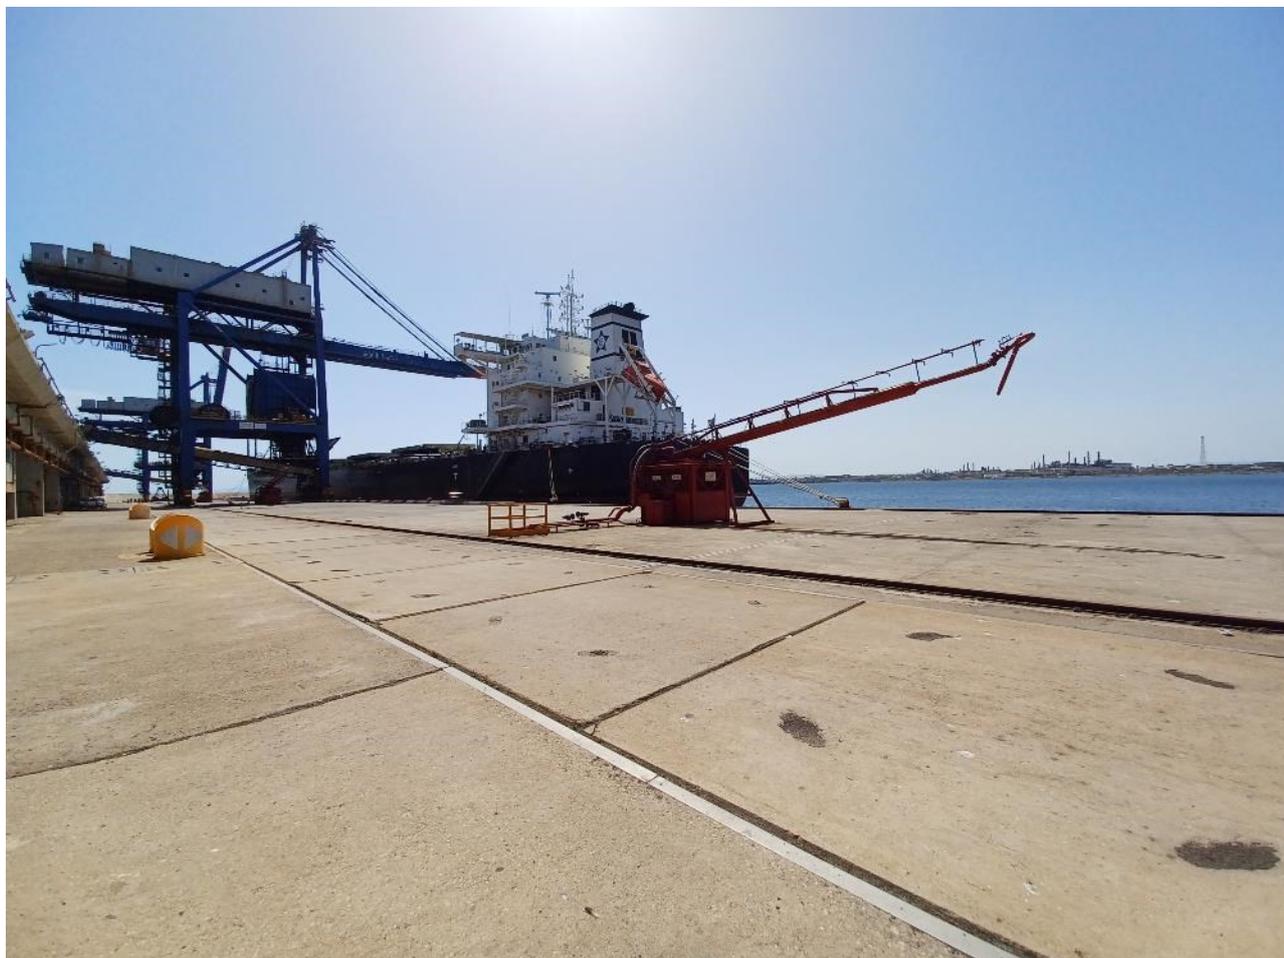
Foto No. 09 – Area ad Est dell’Area di Intervento in Banchina, vista da Ovest
